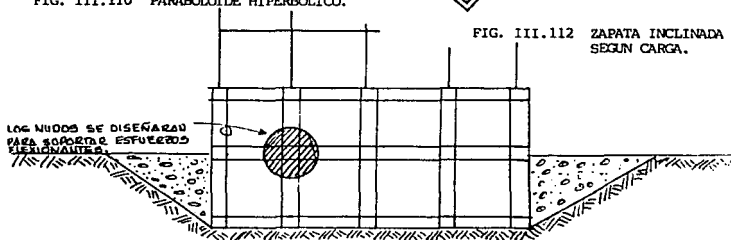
SUBESTRUCTURA DE PORTICO RIGIDO.
